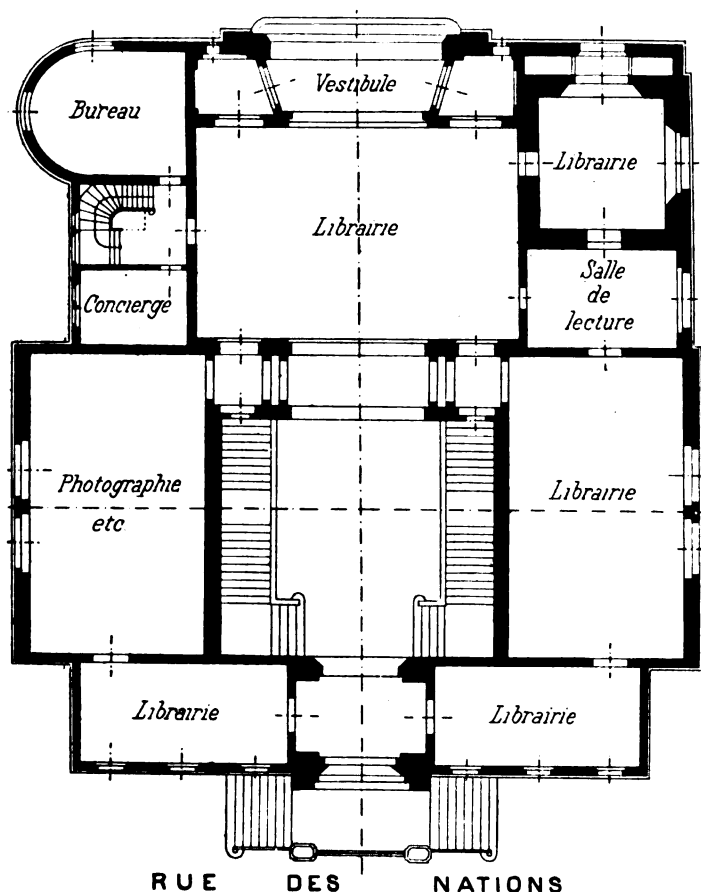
Plan du rez-de-chaussée du pavillon de l'Allemagne.
